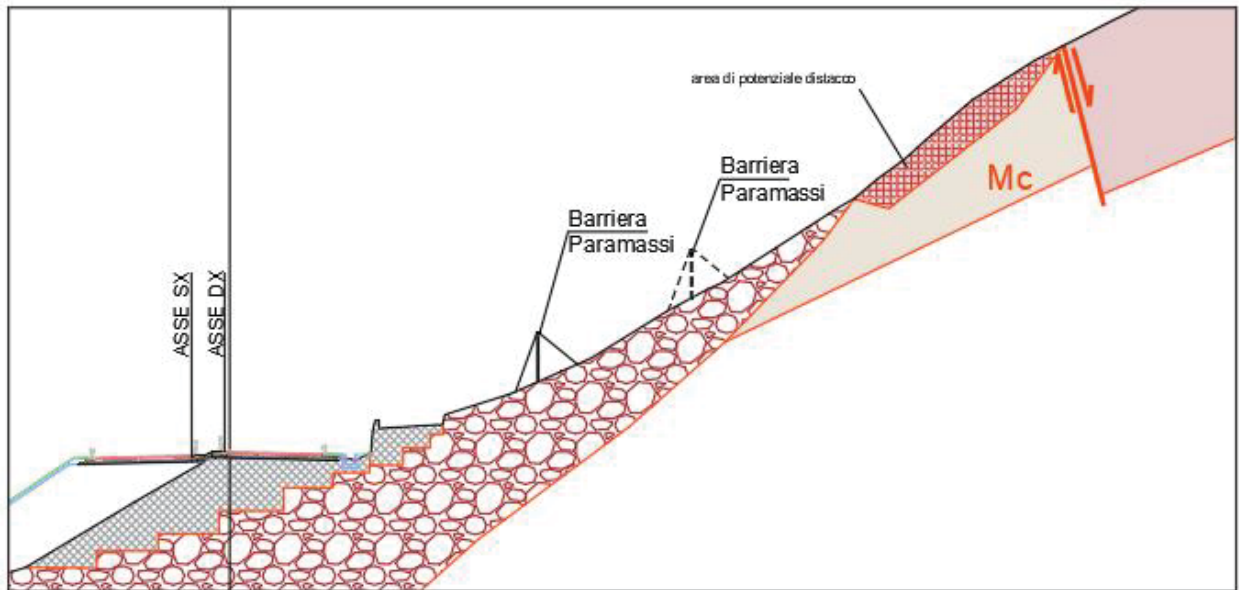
Stralcio della Sez. 2 con ubicazione delle barriere paramassi.
